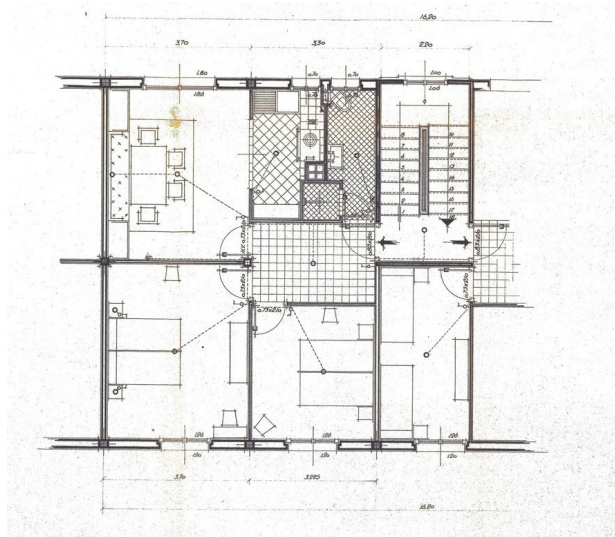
Distribución en planta del bloque D del barrio de San Ignacio de Loyola diseñado por Hilario Imaz, Germán Aguirre, y Luis Lorenzo Blanc. Bilbao, junio de 1944. Fuente: AGAPCAE. Fondo Vivienda. Sección Viviendas de Protección Oficial. Serie construcción de viviendas del INV y de la OSH. Expediente constructivo del Grupo San Ignacio de Loyola de Bilbao, 1ª fase. Caja: EBCIO-00006. Signatura: G-140-1.
